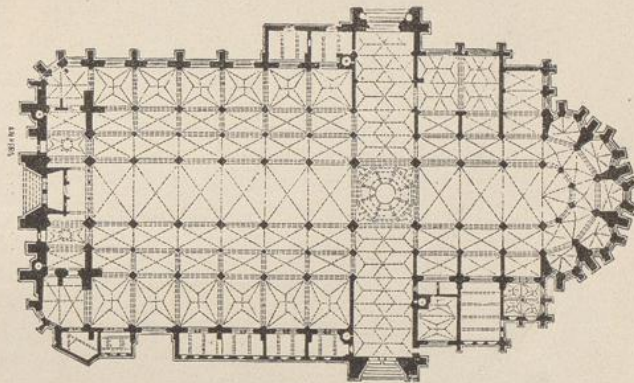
Grundriss der Kathedrale von Antwerpen
